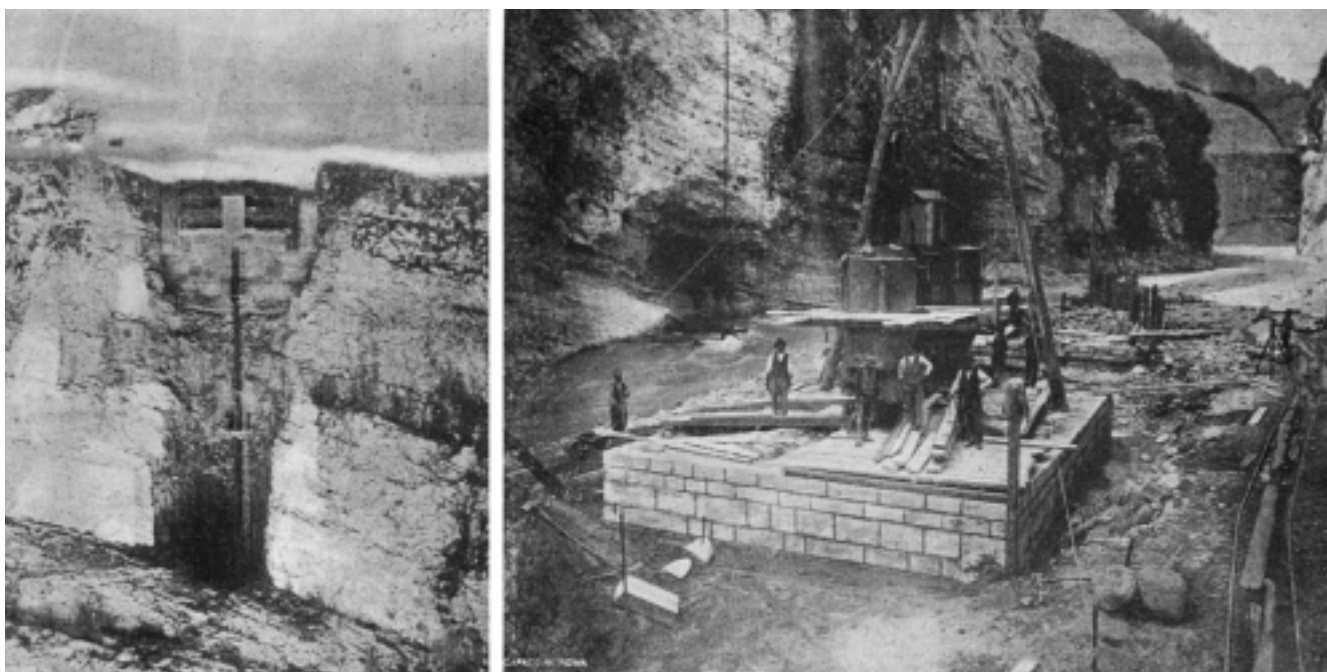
Paratoia di chiusura della deviazione provvisoria e fase iniziale di realizzazione del pilone centrale in elevazione dal cassone II di fondazione.
